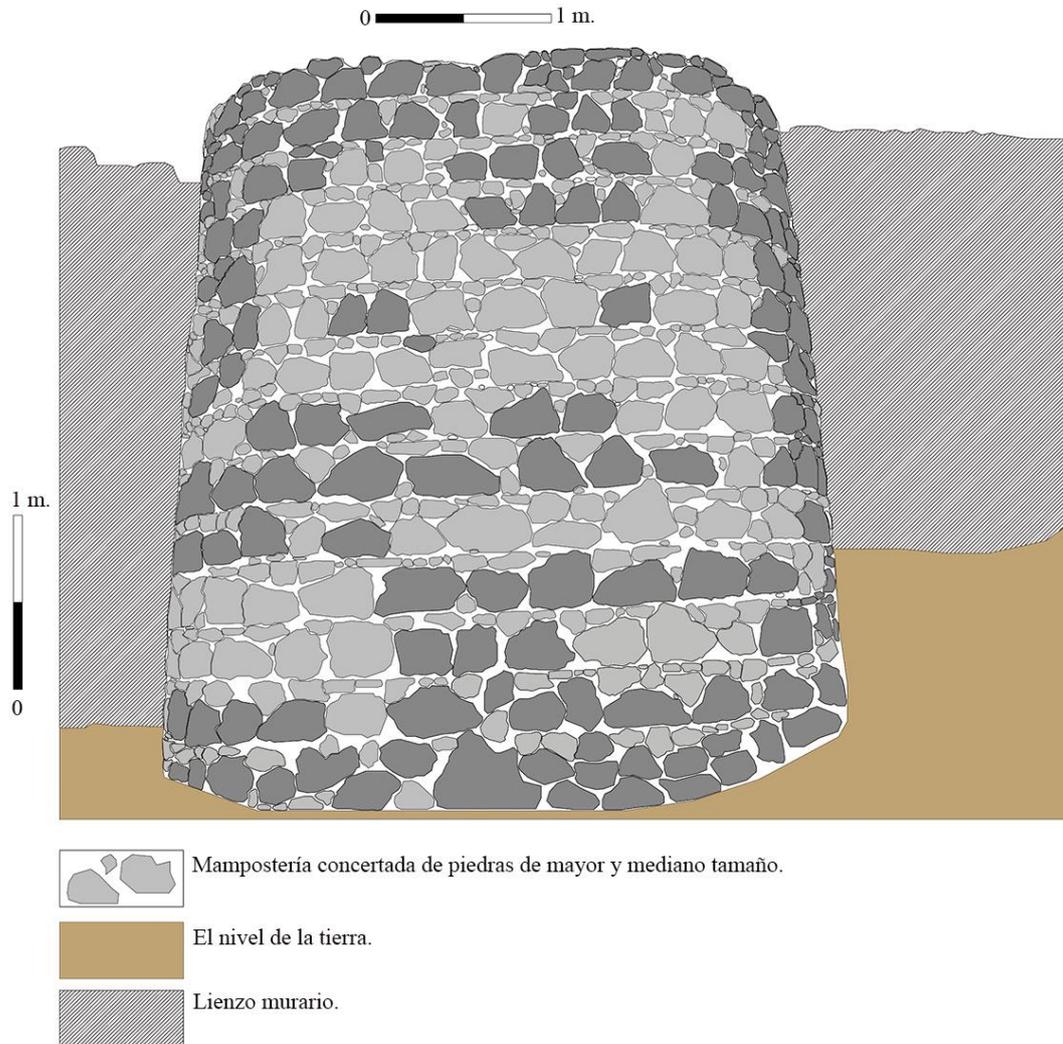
Torre (T_12) en su cara (sureste). La técnica constructiva, mampostería concertada con verdugadas de piedra y ladrillo. (Elaboración propia).
